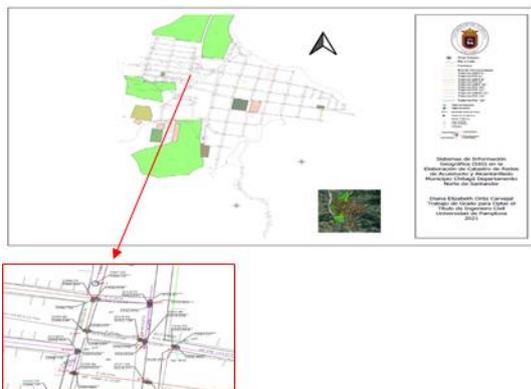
Plano SIG QGIS Sistema de Alcantarillado
